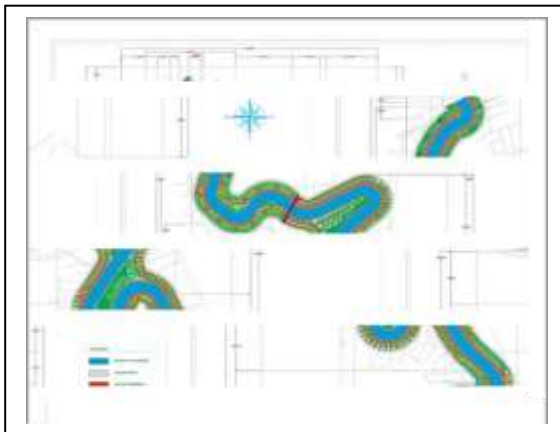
Siteplan perencanaan RTH pada Sempadan Sungai Ciliwung
